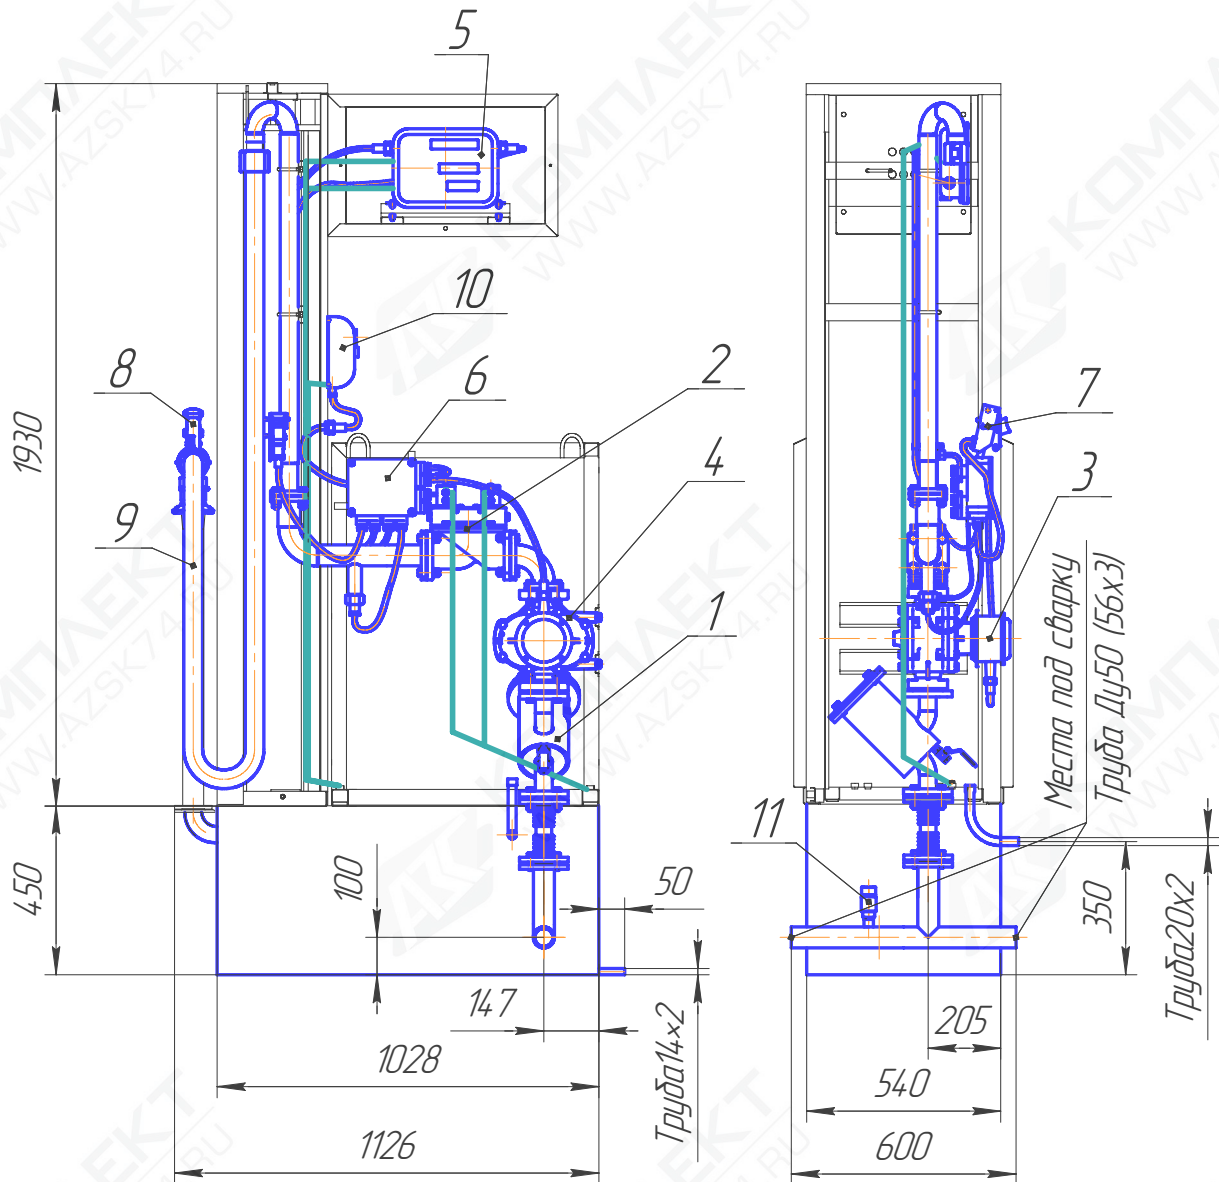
Установка топливораздаточная 2 УТЭД с двумя клапанами КЭГ.
